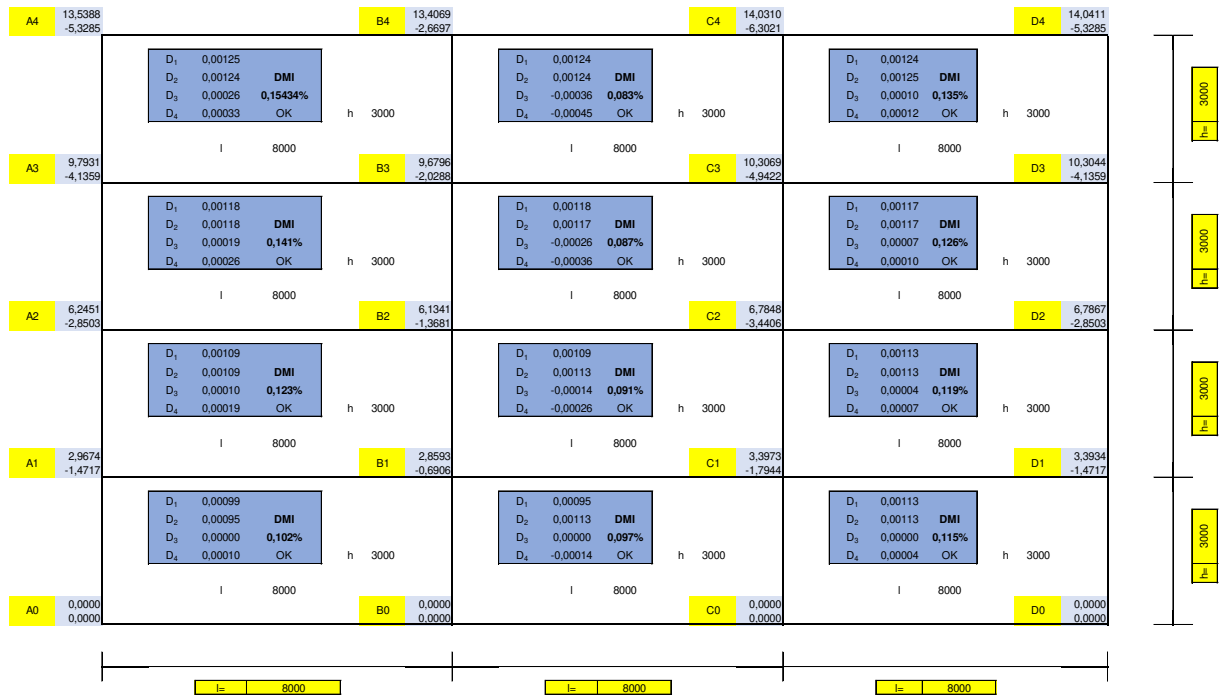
Avaliação das distorções do 13º ao 16º pavimento.
